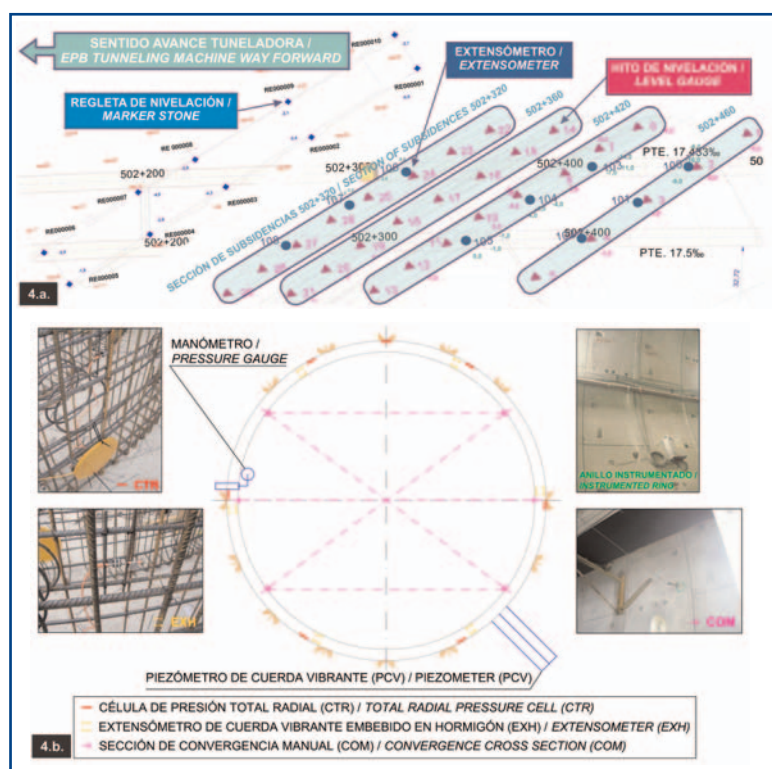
Detalle de instrumentación del perfil 1. a) En planta -secciones de subsidencias-; b) En anillo de sección tipo instrumentado/Detailed view of the instrumentation of profile 1 (a: in plan view -subsidence sections-; b: in the segmented cross-section ring).
